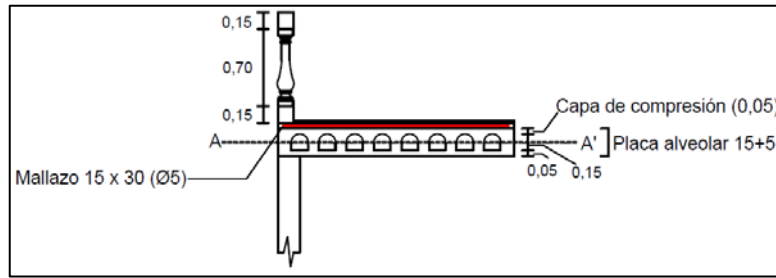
Detalle de la placa alveolar, entre otros elementos
